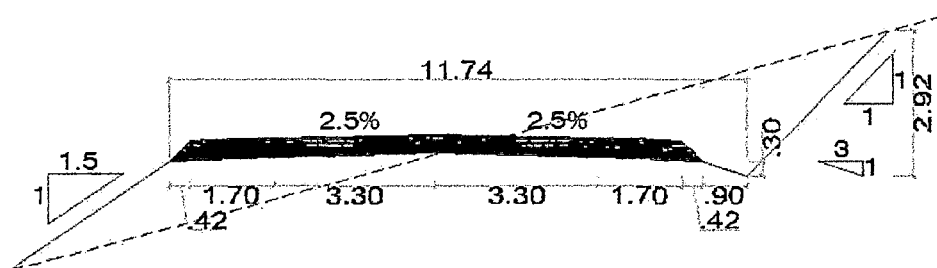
Sección transversal (en corte y relleno) en tangente sin banquetas - Fuente. Elaboración Propia
